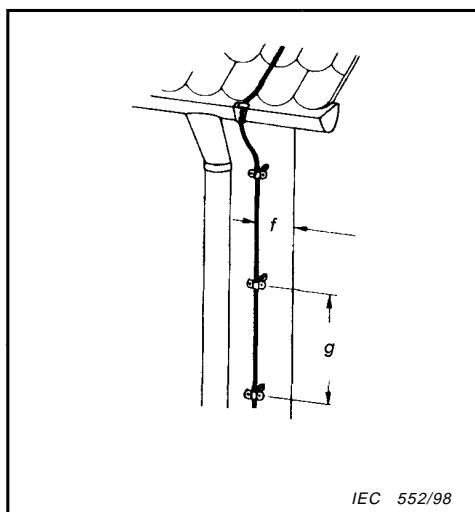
Installation d'un conducteur de descente avec connexion à la gouttière
